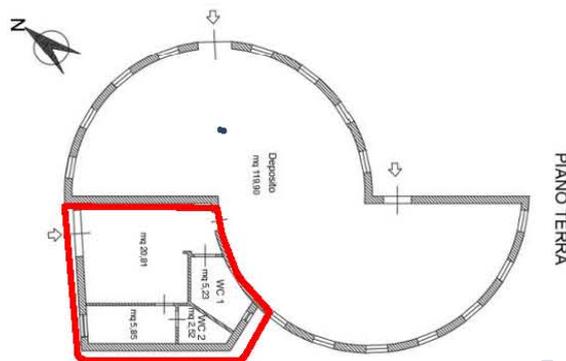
Pianta con individuazione degli abusi ancora non sanati
